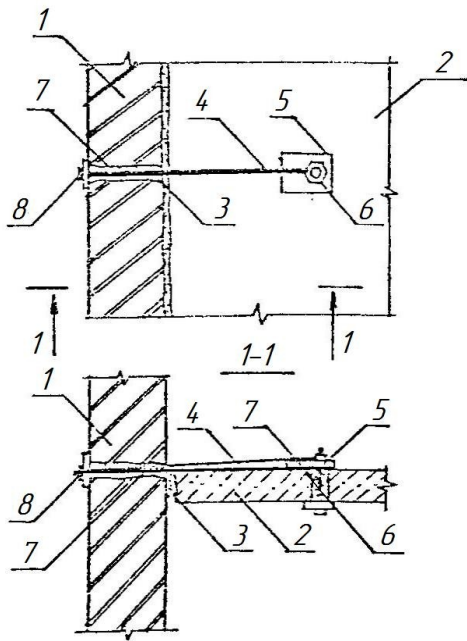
Посилення вузлів сполучення цегляних стін з'єднанням зовнішніх стін із плитами перекриття тяжами: 1 – зовнішня стіна; 2 – залізобетонне перекриття; 3 – тріщина між стіною й перекриттям; 4 – тяжі, приварені до пластин; 5 – металеві пластини; 6 – болт; 7 – отвори в стінах; 8 – гайки для натягу
